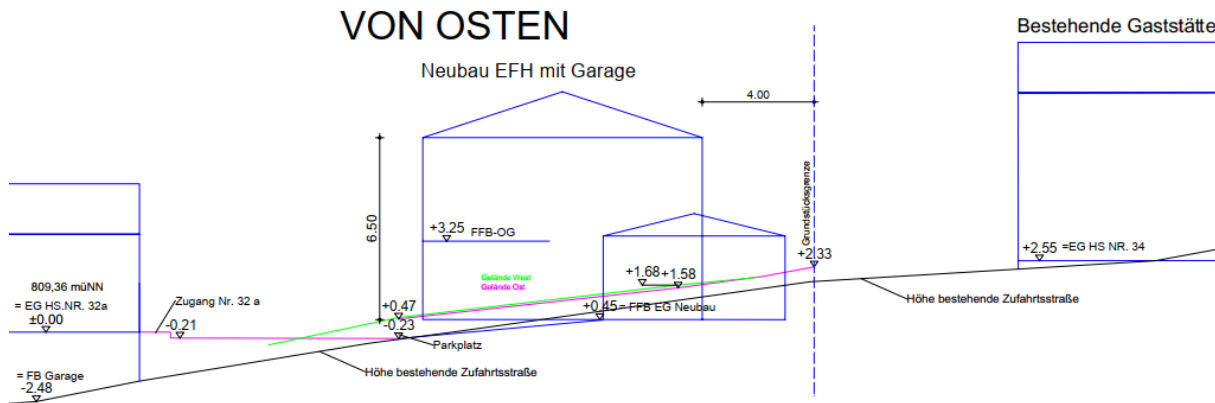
Höhenlage und Schnitt des geplanten Neubaus
